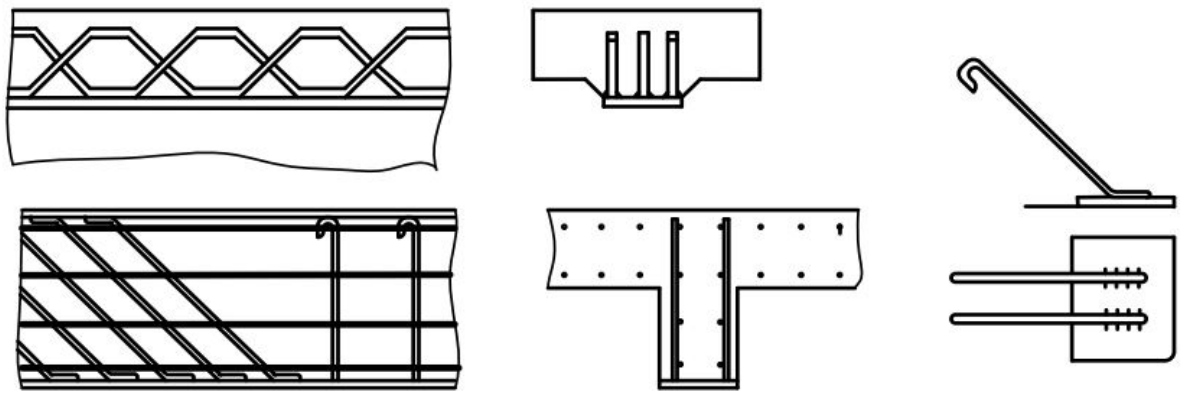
Окремі деталі, які приварюються за допомогою ручного зварювання
